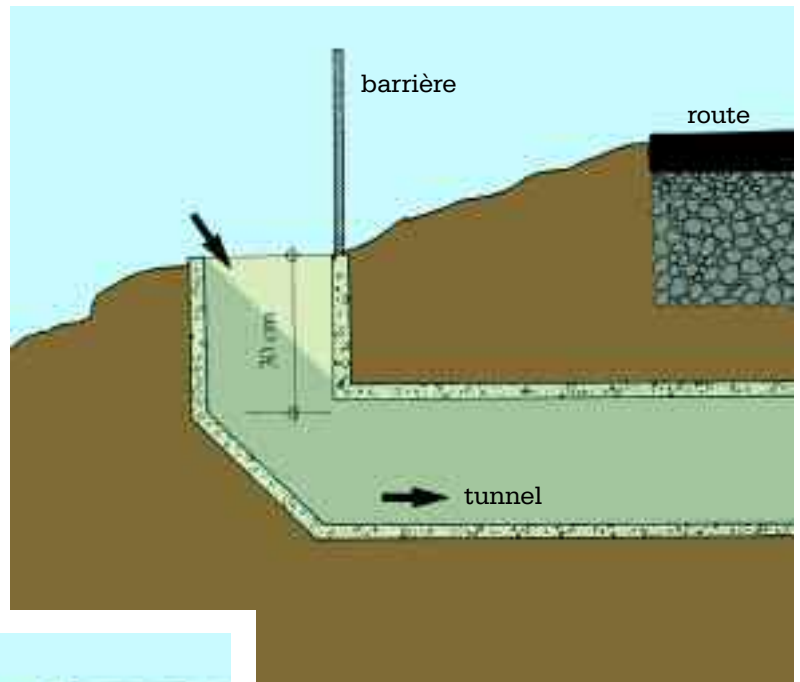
Trou de chute au fond d'un canal en U (coupe verticale).
